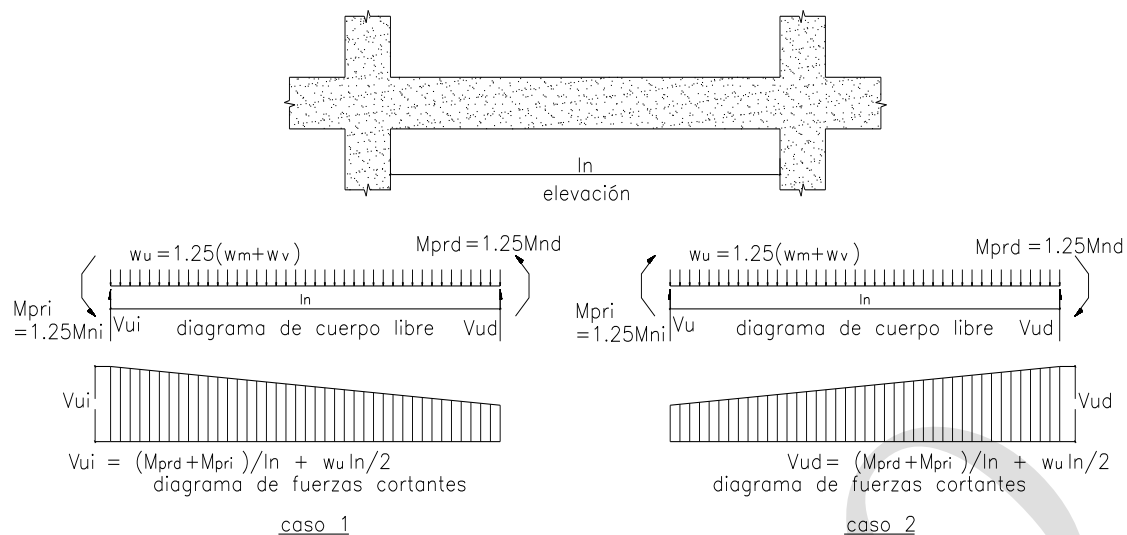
Fuerza cortante de diseño en vigas
